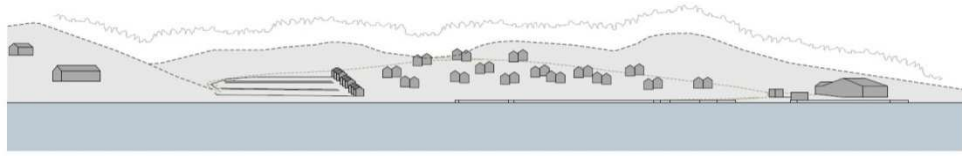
Pargas port, stranddetaljplan och stranddetaljplanändring, utkast 17.04.2024, illustrationsbild
